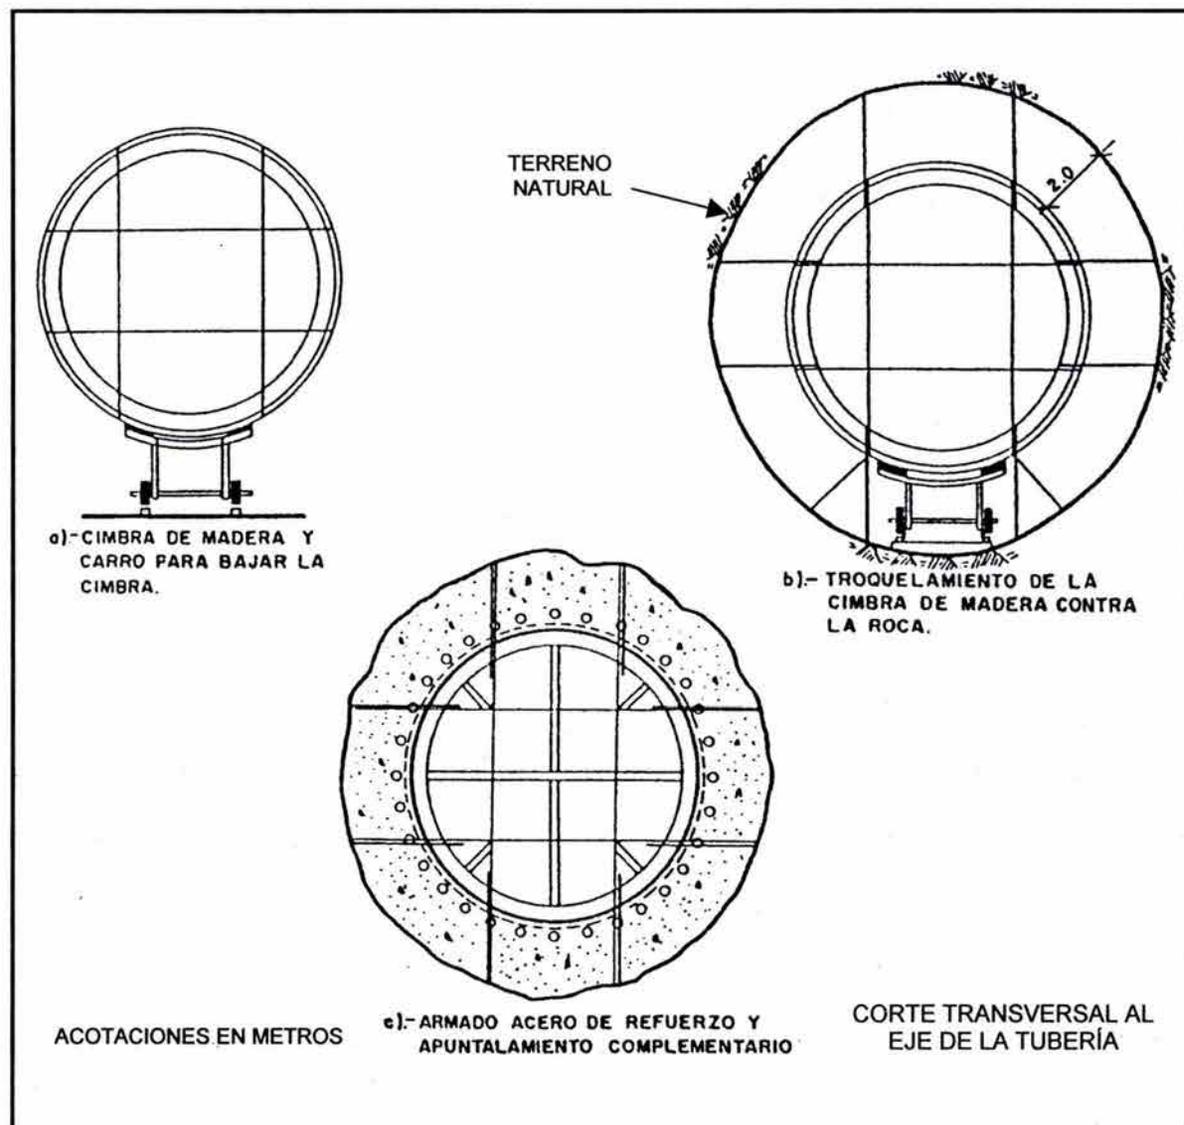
ELEMENTOS EMPLEADOS EN EL CIMBRADO
